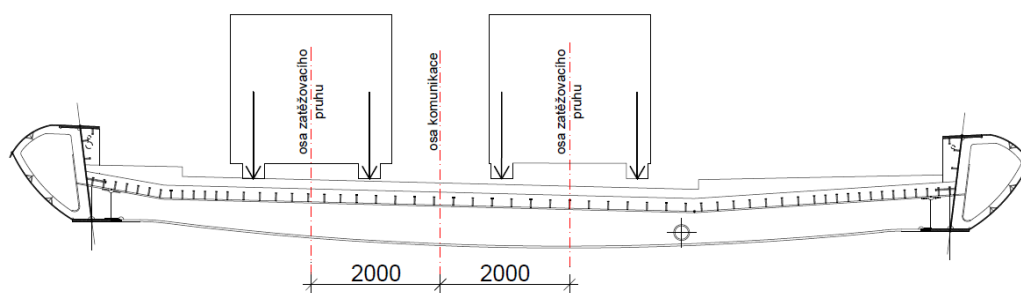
Schéma zatěžovacího stavu ZS3 a ZS4 – půdorys [11]
